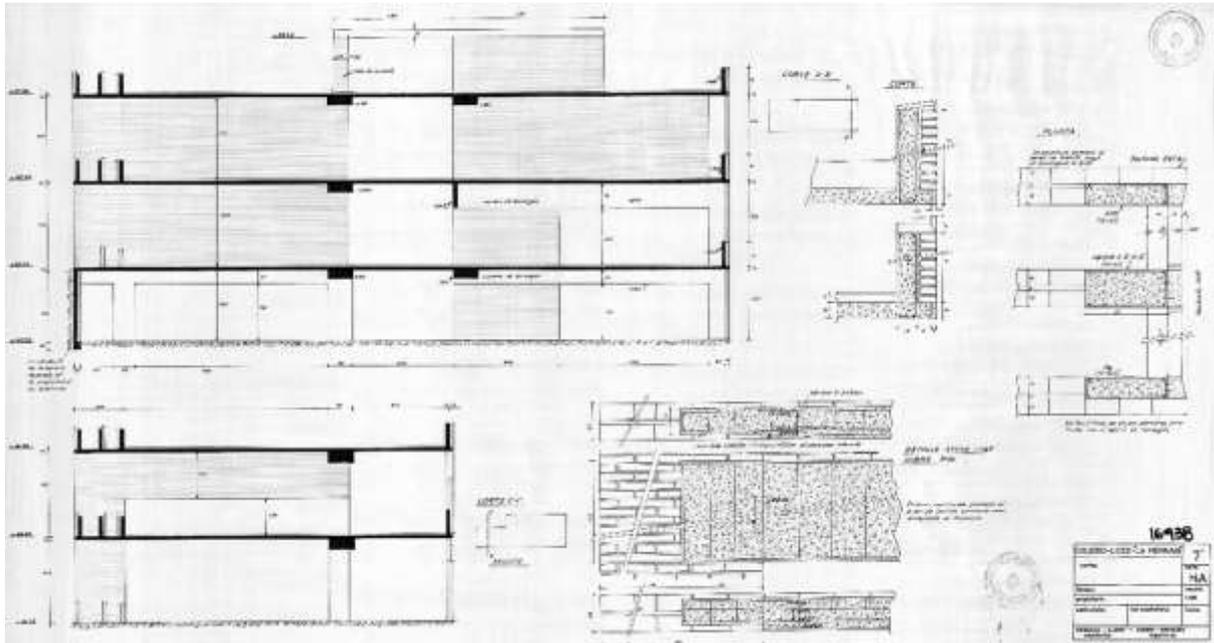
/ 1960. – Plano Estructura HA07' lámina 16938 DDI
